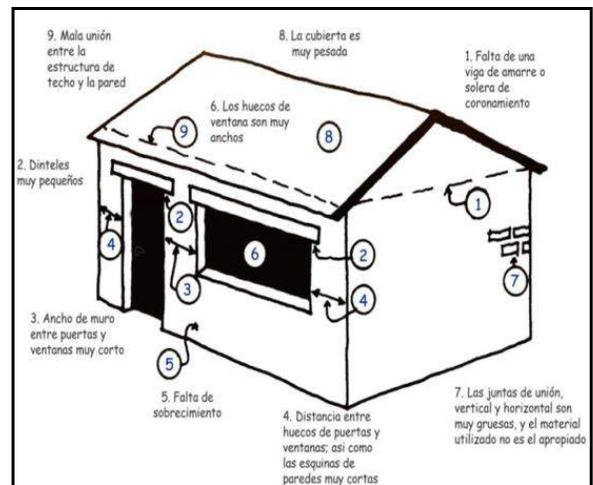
Principales fallas en el sistema constructivo de adobe, investigación de campo Proyecto TAISHIN
